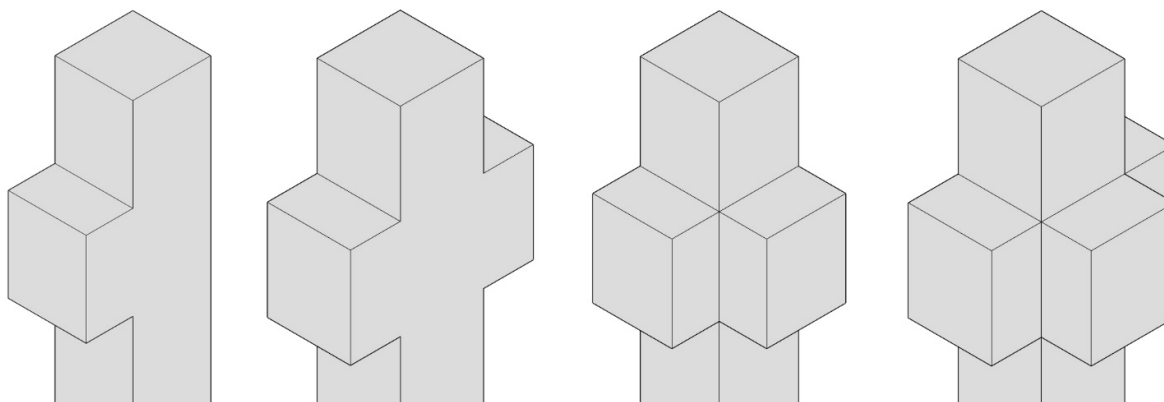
, vista isométrica, pilares con 4 situaciones de cartelas de apoyo, según las vigas concurrentes
